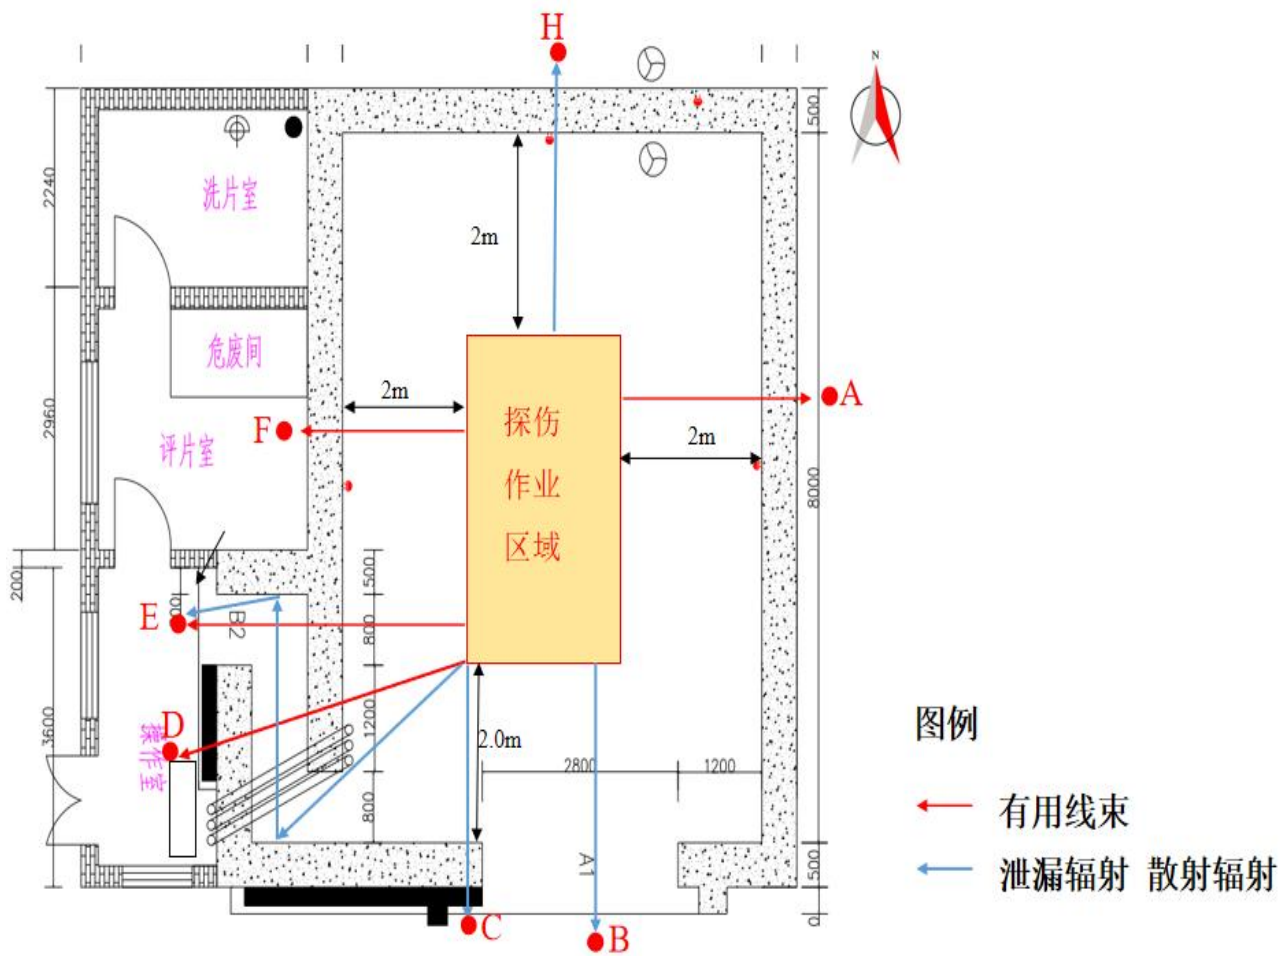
探伤室平面布局及周围环境预测点位示意图（单位：mm）
